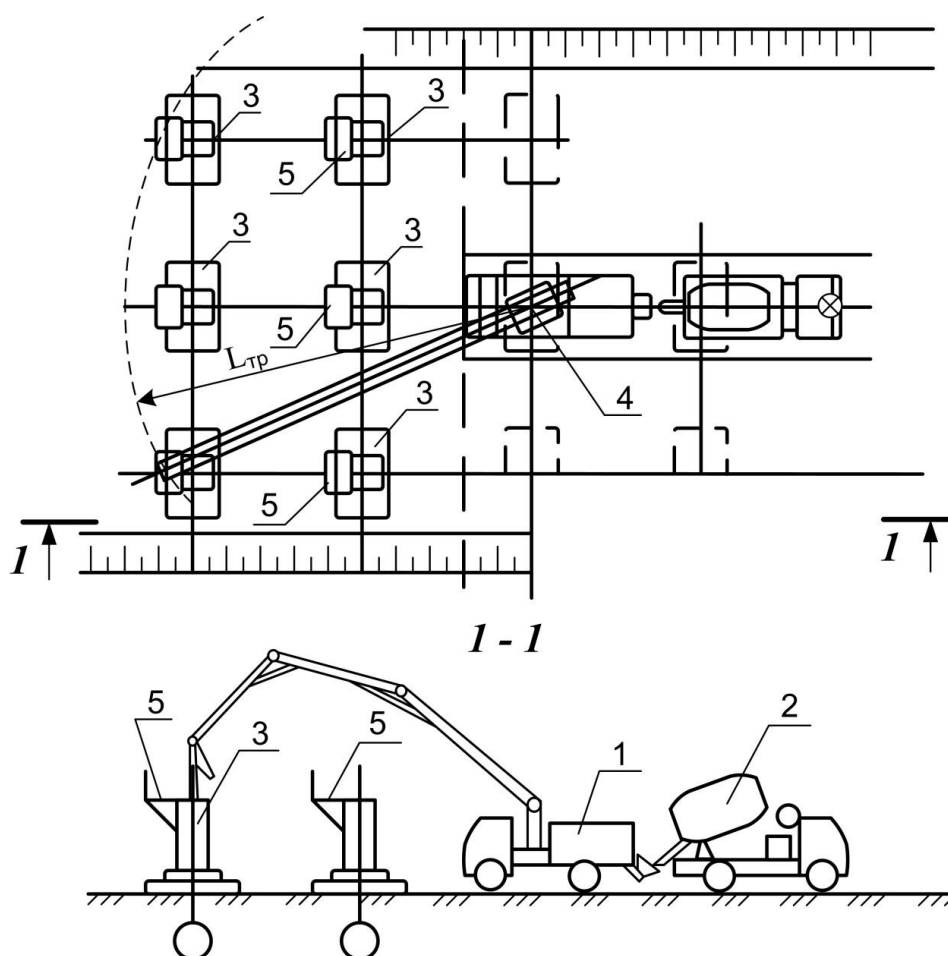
Технологическая схема бетонирования фундаментов при помощи автобетононасоса со дна котлована:
